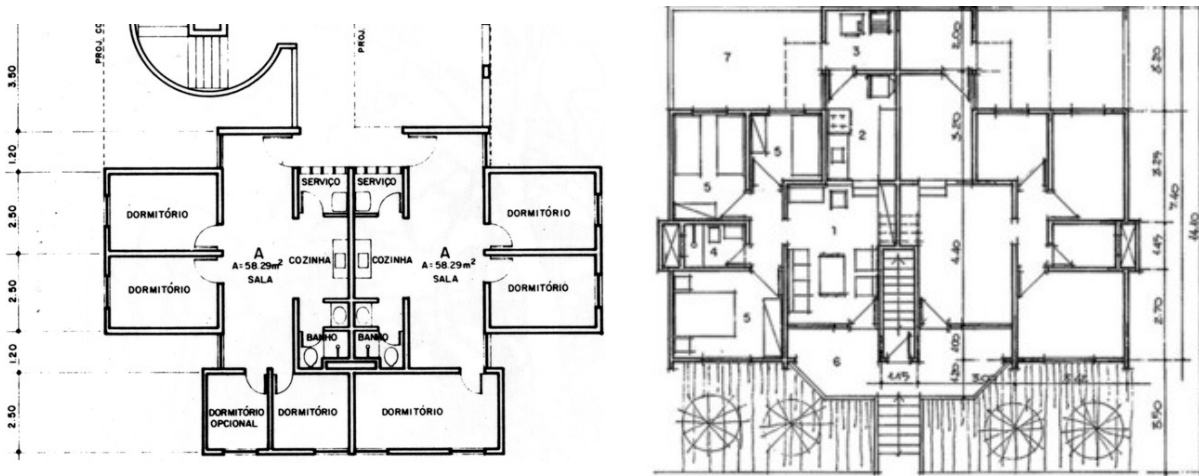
Planta tipo de UH do projeto CDHU em Itatiba (VA-14). Planta tipo de UH do projeto Conjunto em Itatiba (M-03).
